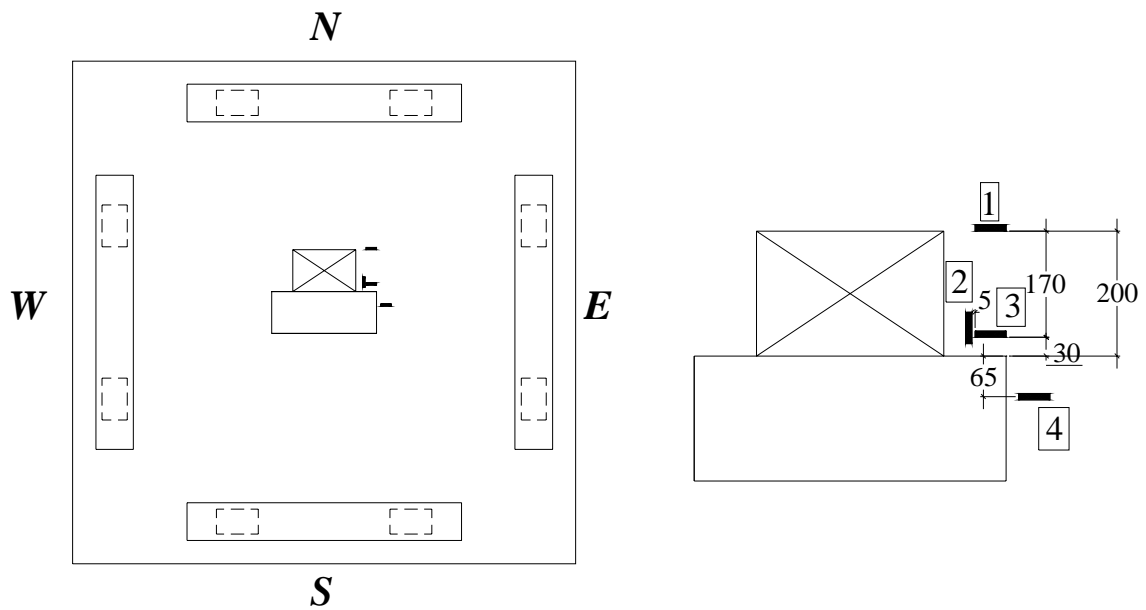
Posicionamento dos EERs do concreto nas lajes L16, L17 e L19 (mm)
